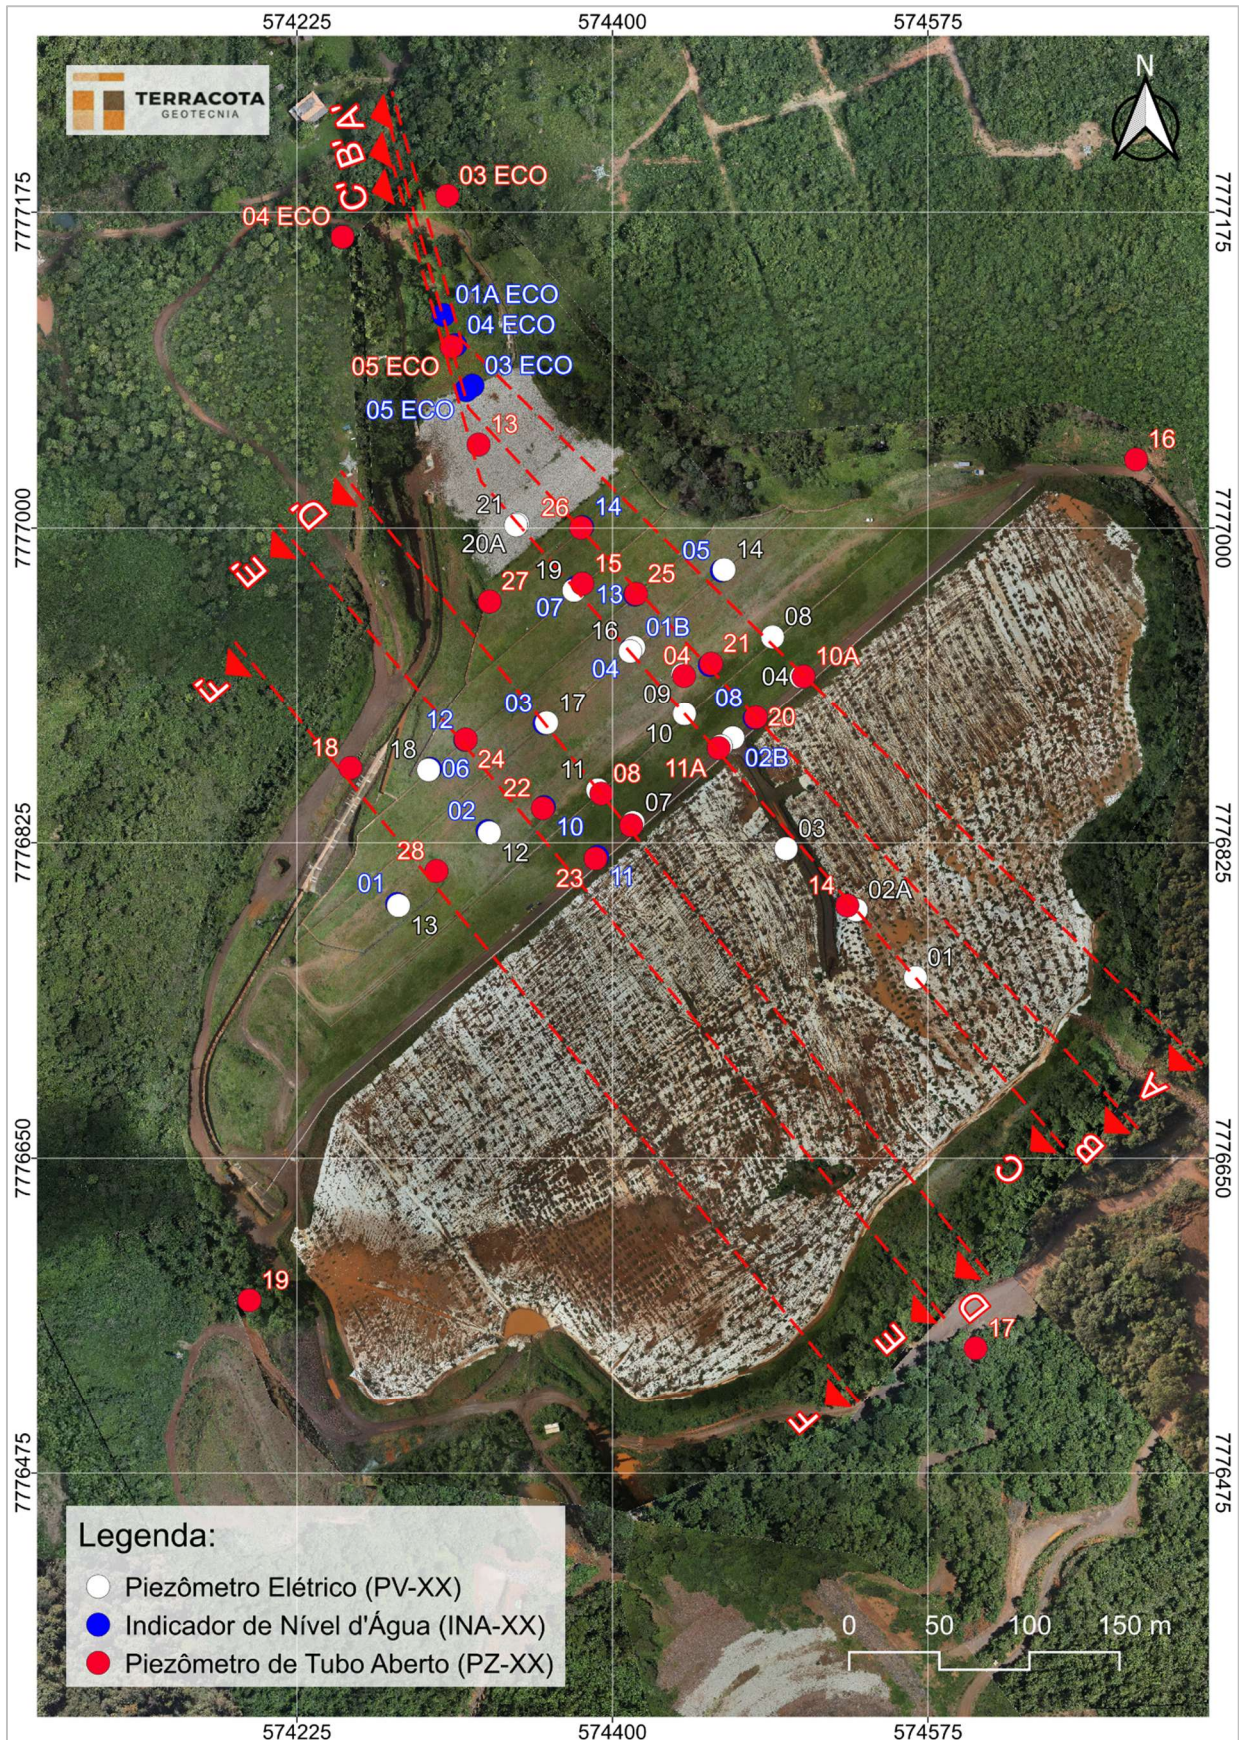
Seções Instrumentadas Barragem B1-Auxiliar – Mina Tico-Tico – Planta.
